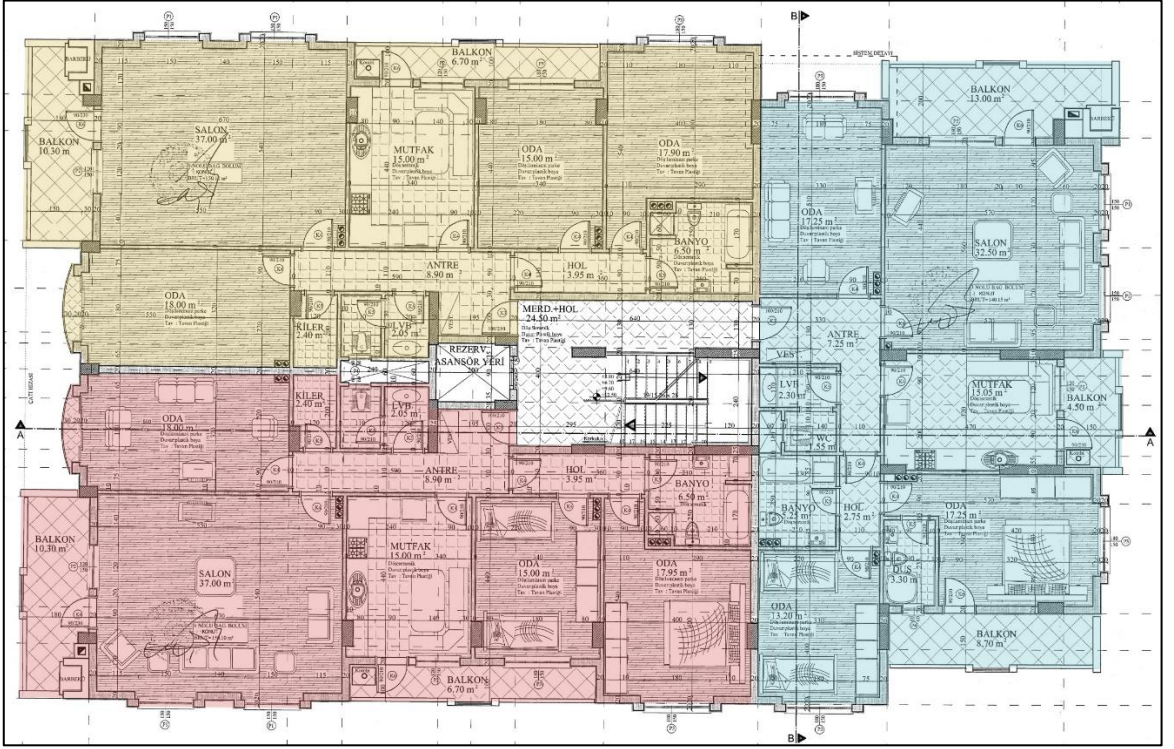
Altın Kent Sitesi Vaziyet Planı
